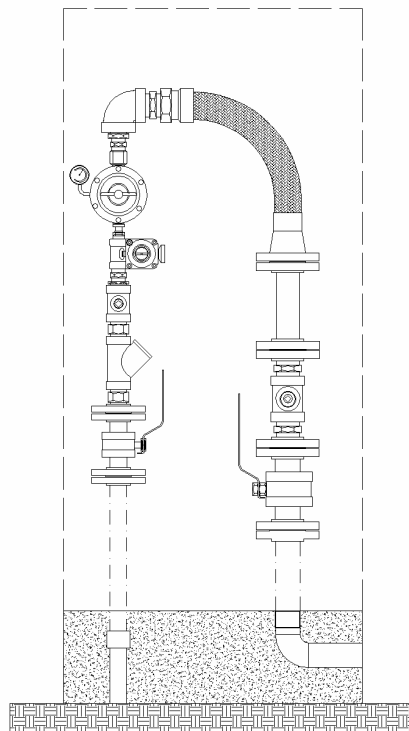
Exemplo de estação residencial (ERP ER "A"), com base de concreto e projeção do abrigo metálico
